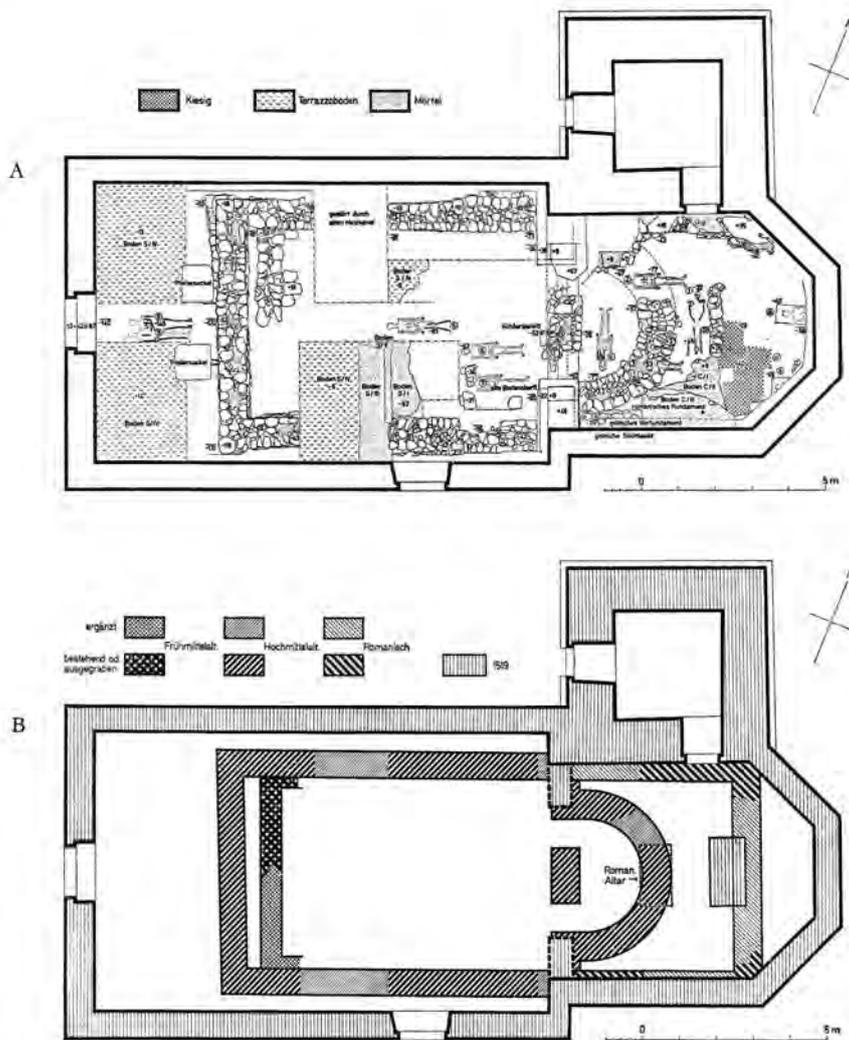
Knonau ZH, Kirche. Ausgrabung 1960. – A: Steingerechter Plan. B: Bautappenplan. – 1:200.
